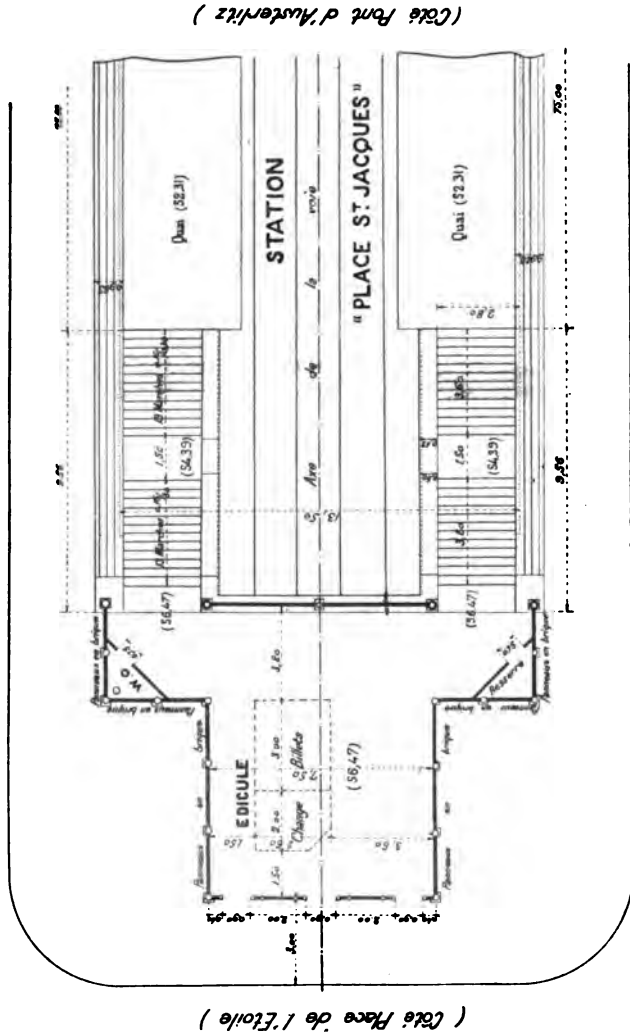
(Ech. 1/250.) — Accès à la station « Place Saint-Jacques ». — Plan.
